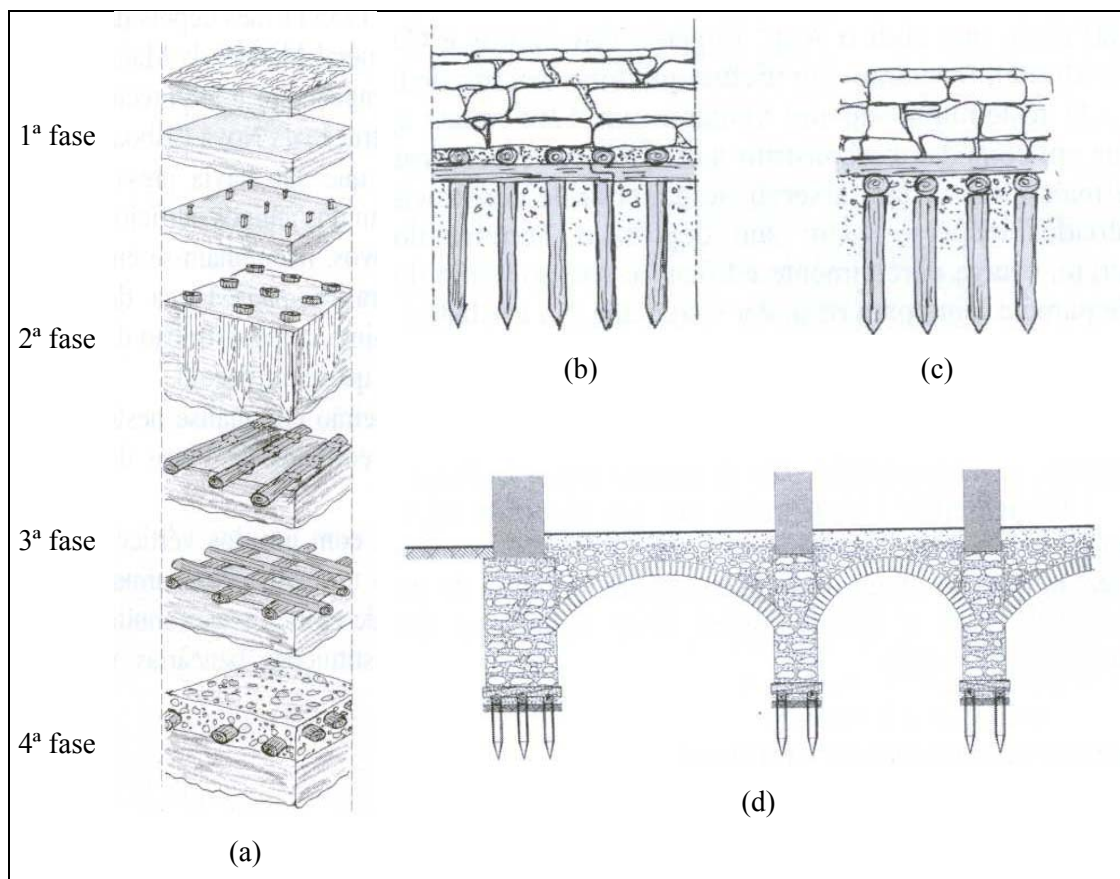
Aspectos construtivos das fundações em edifícios da Baixa Pombalina - Lisboa, na reconstrução após o terramoto de 1755: (a) fases de construção; (b) corte longitudinal; (c) corte transversal; (d) pormenor do arranque da estrutura sobrejacente à estrutura das fundações.
